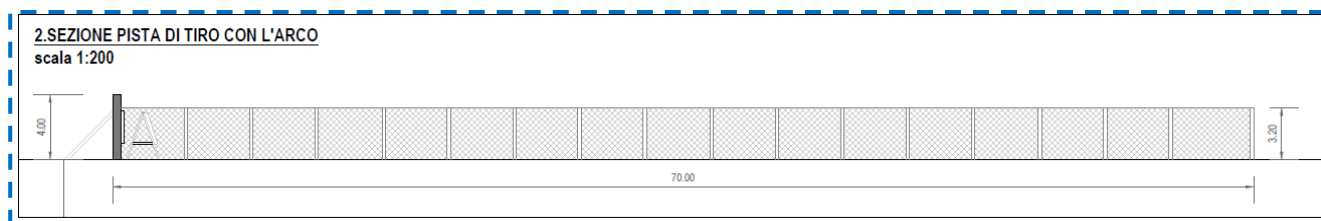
Estratto tav.04.d: sezione pista di tiro con l'arco e Telo batti frecce
